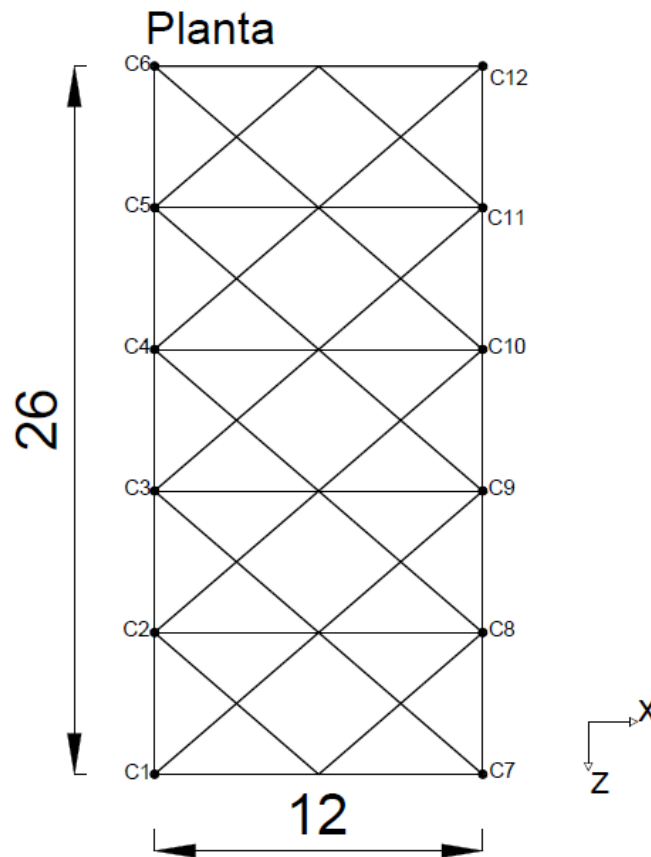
Planta de la Estructura-Columnas Referenciadas
